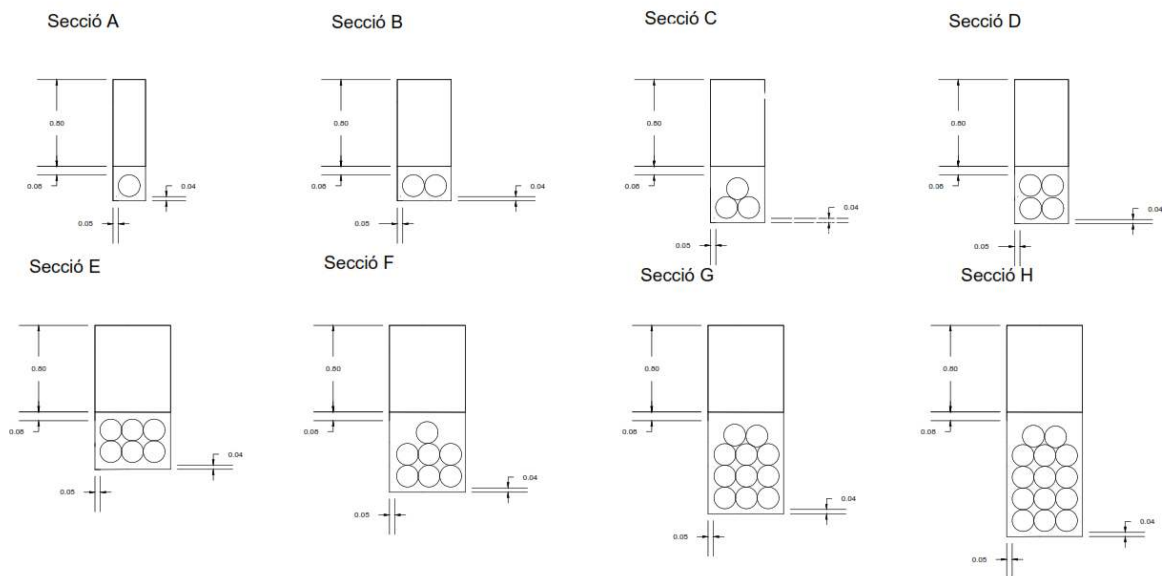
Seccions de tubs enterrats utilitzades per a la connexió dels inversors elevadors a la subestació
